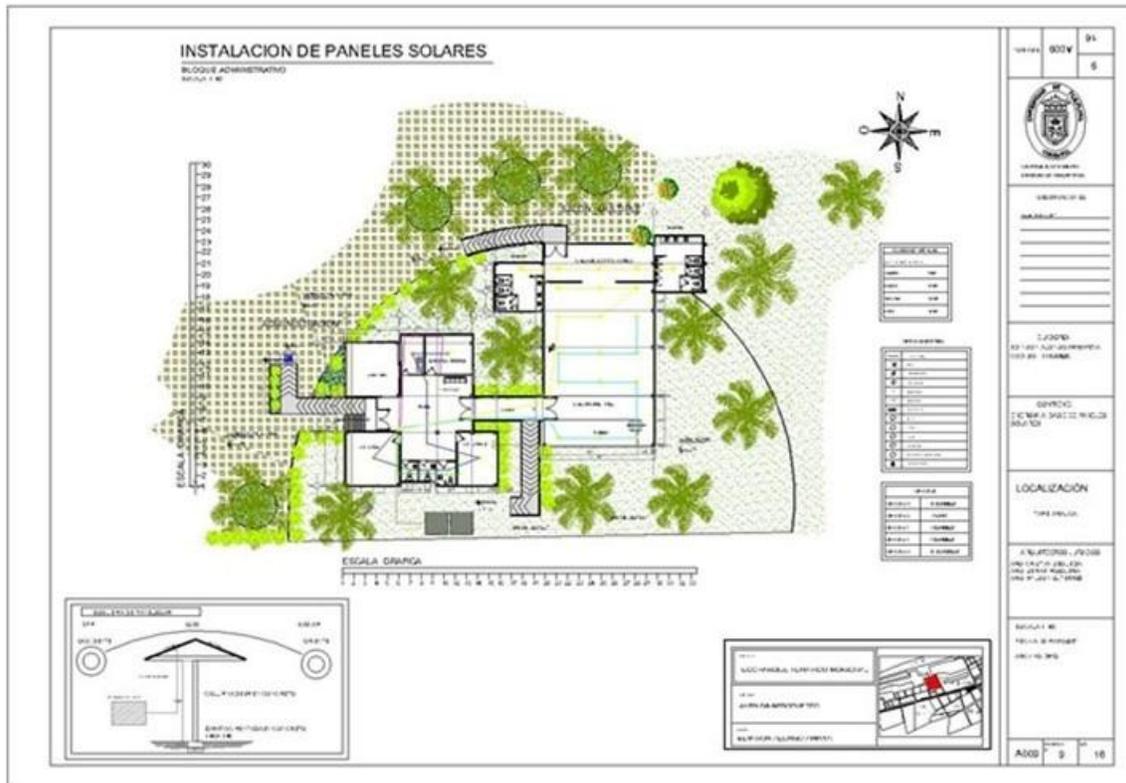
Planta de instalación eléctrica, zona administrativa
